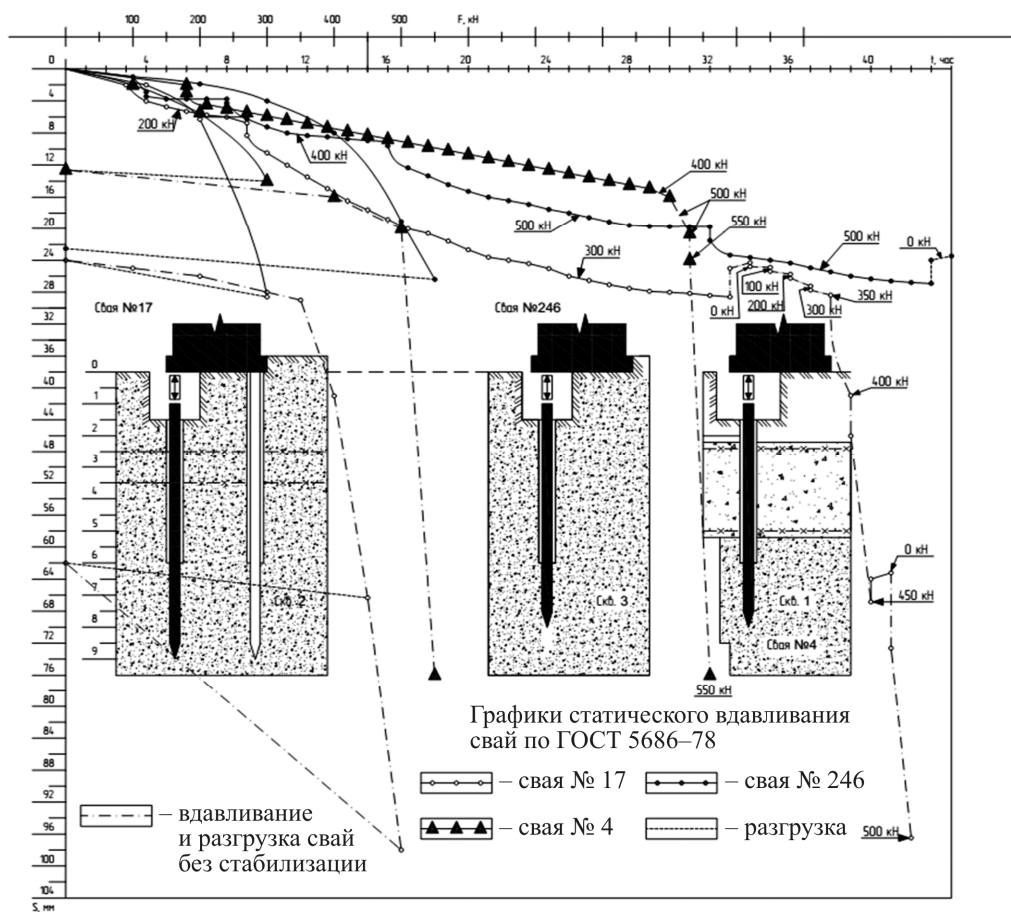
Результаты испытаний свай в фундаменте возведенного здания аэровокзала
